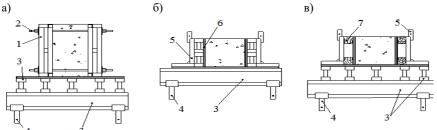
Схемы устройства опалубки монолитной балки: а — с применением инвентарных опалубочных щитов; б — с применением опалубочных балок; в — с применением деревофанерных щитов: 1 — инвентарный щит; 2 — винтовой тяж; 3 — опалубочная балка; 4 — опорная система; 5 — бортовой упор; 6 — водостойкая ламинированная фанера; 7 — деревофанерный щит
